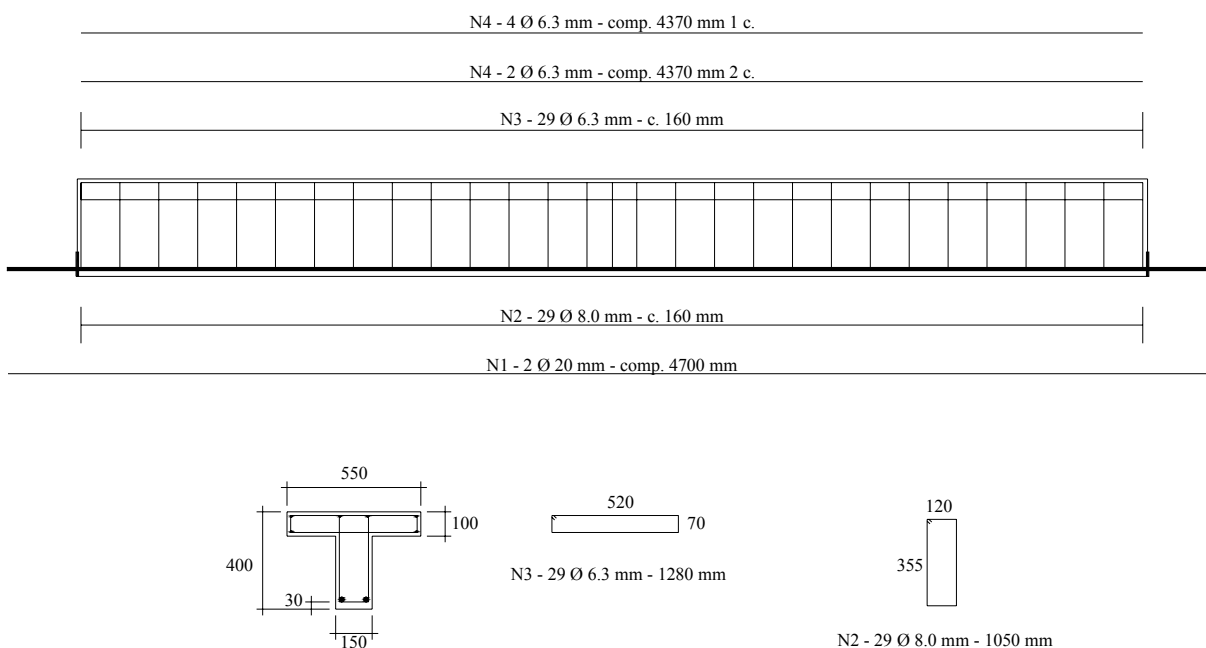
Detalhamento da armadura das vigas do Grupo A
